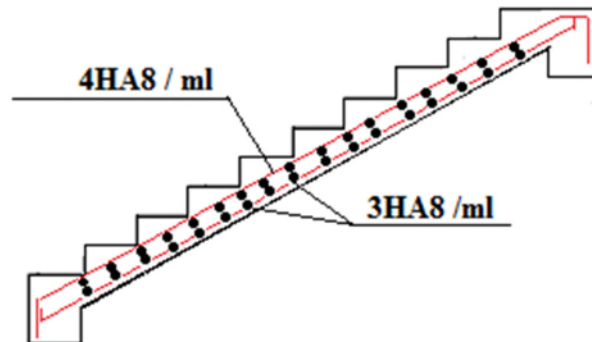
Schéma de ferrailage de l'escalier droit à 2 volées
